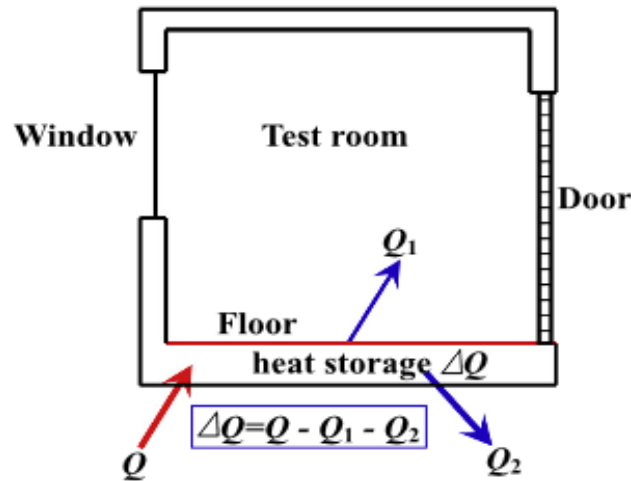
Schéma de bilan thermique du plancher chauffant [43]
